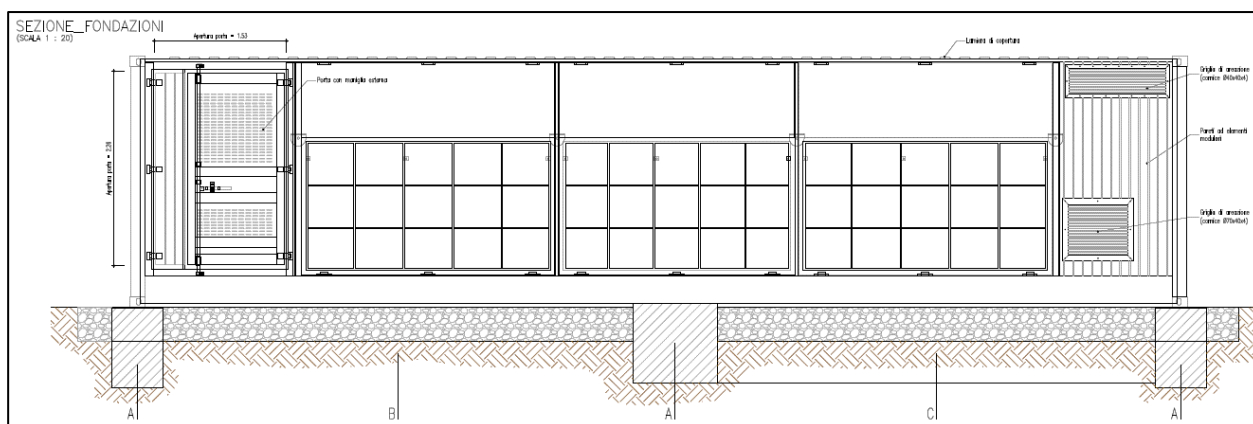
Sezione fondazioni di una cabina di campo e trasformazione
